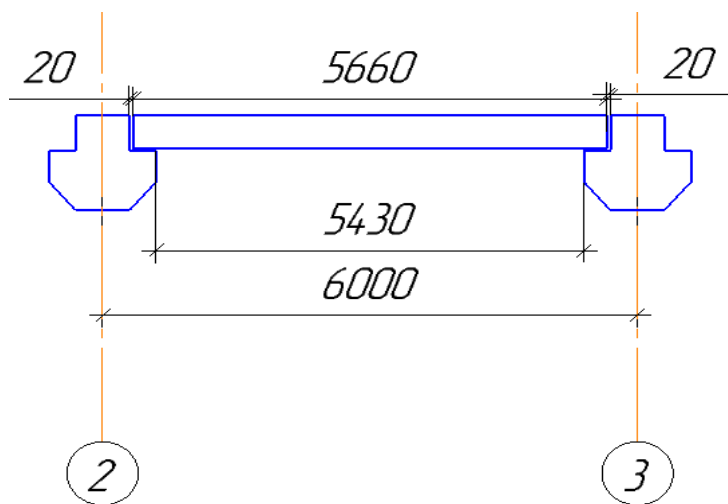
Определение конструктивной длины и расчетного пролета панели.
